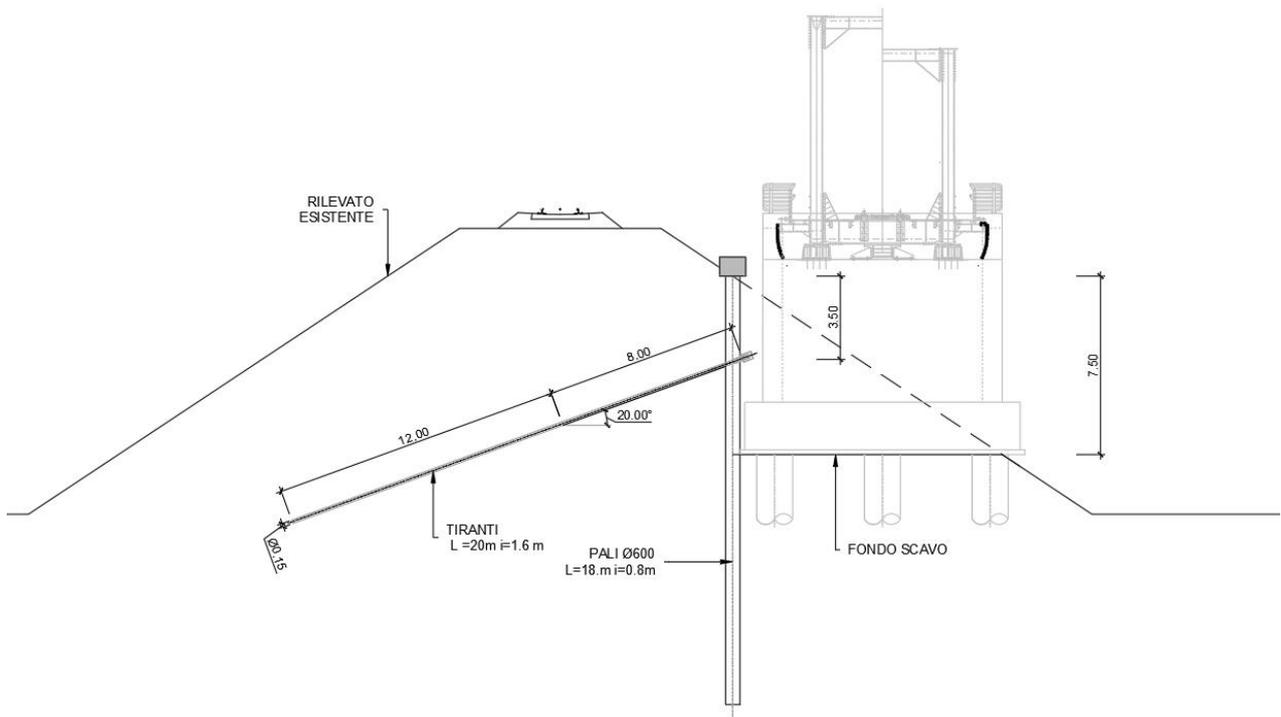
OOPP Spalle e Pile P2 P3
